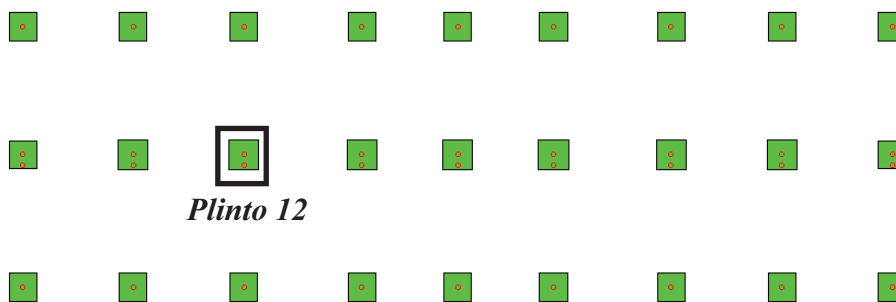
Estratto Pianta delle Fondazioni - Edificio 1
